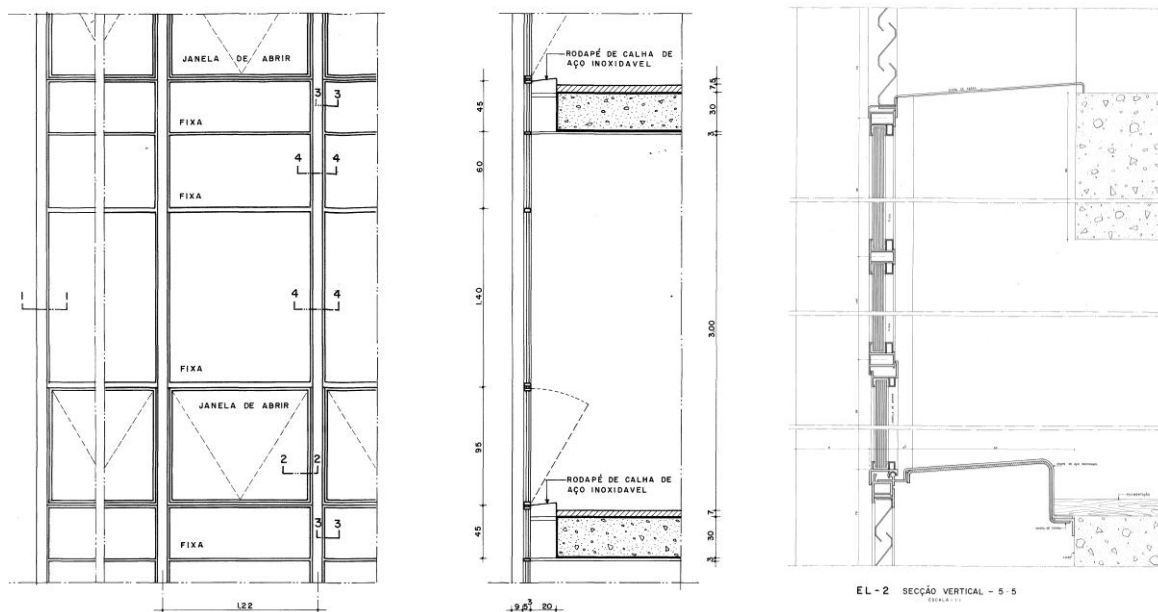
Vista, corte e detalhe do afastamento da esquadria em relação à estrutura de concreto. Fonte: desenhos originais de Garcia Roza.
